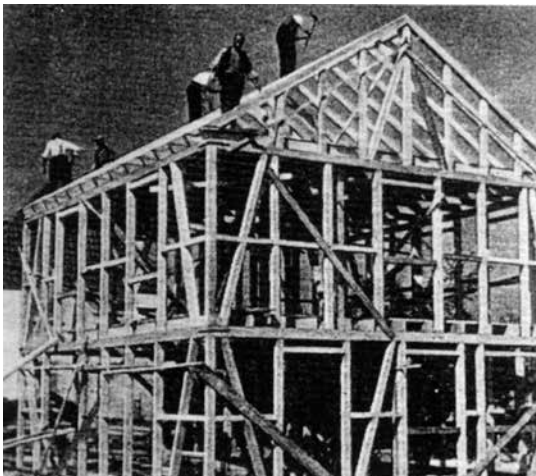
Sistema mejorado, vivienda No. 5, bajo construcción, 1933.
